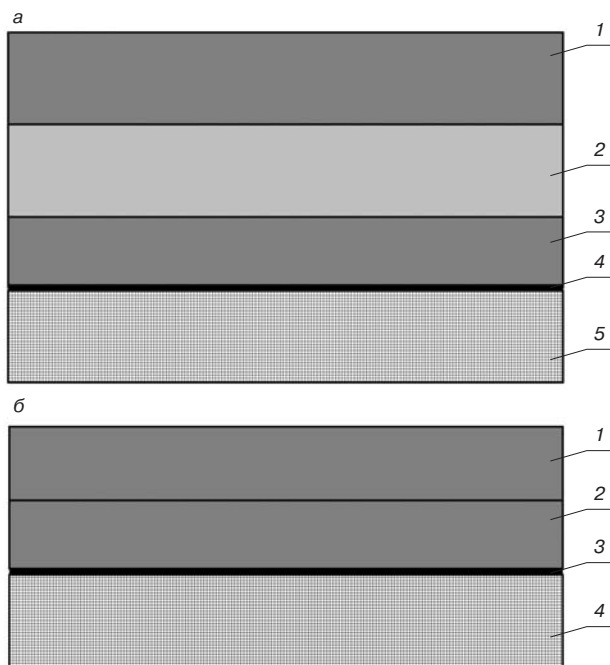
Конструкции дорожной одежды мостового полотна, рекомендуемые к применению на железобетонной плите Б: с покрытием из литой сероасфальтобетонной смеси: а – проезжая часть: 1 – литой сероасфальтобетон I типа, слоем 40 мм; 2 – асфальтобетон типа А, Б или литой сероасфальтобетон I типа, слоем 40 мм; 3 – мастика битумно-полимерная наполненная, расход 55 кг/м², слоем 20 мм; 4 – эмульсия битумно-полимерная, расход 0,7–0,8 кг/м²; 5 – железобетонная плита; б – тротуар: 1 – литой сероасфальтобетон II типа, слоем 30 мм; 2 – мастика битумно-полимерная наполненная, расход 55 кг/м², слоем 10 мм; 3 – эмульсия битумно-полимерная, расход 0,7–0,8 кг/м²; 4 – железобетонная плита
